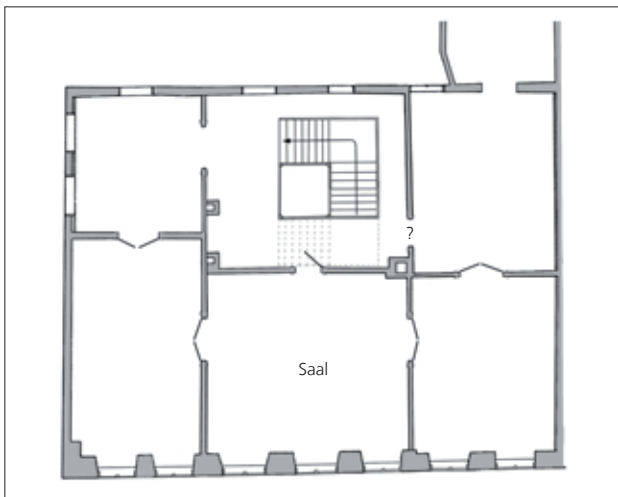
Greifswald, Fleischerstraße 17. Rekonstruktionsversuch für den Grundriss des Obergeschosses nach dem Umbau um 1780. Maßstab 1:250. Zeichnung: T. Rütz (2014). Plangrundlage: Architekturbüro Stadt & Haus (1992)
